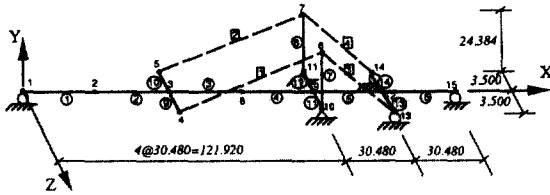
3-dimensional Cable-Stayed Bridge Model used in this study.
